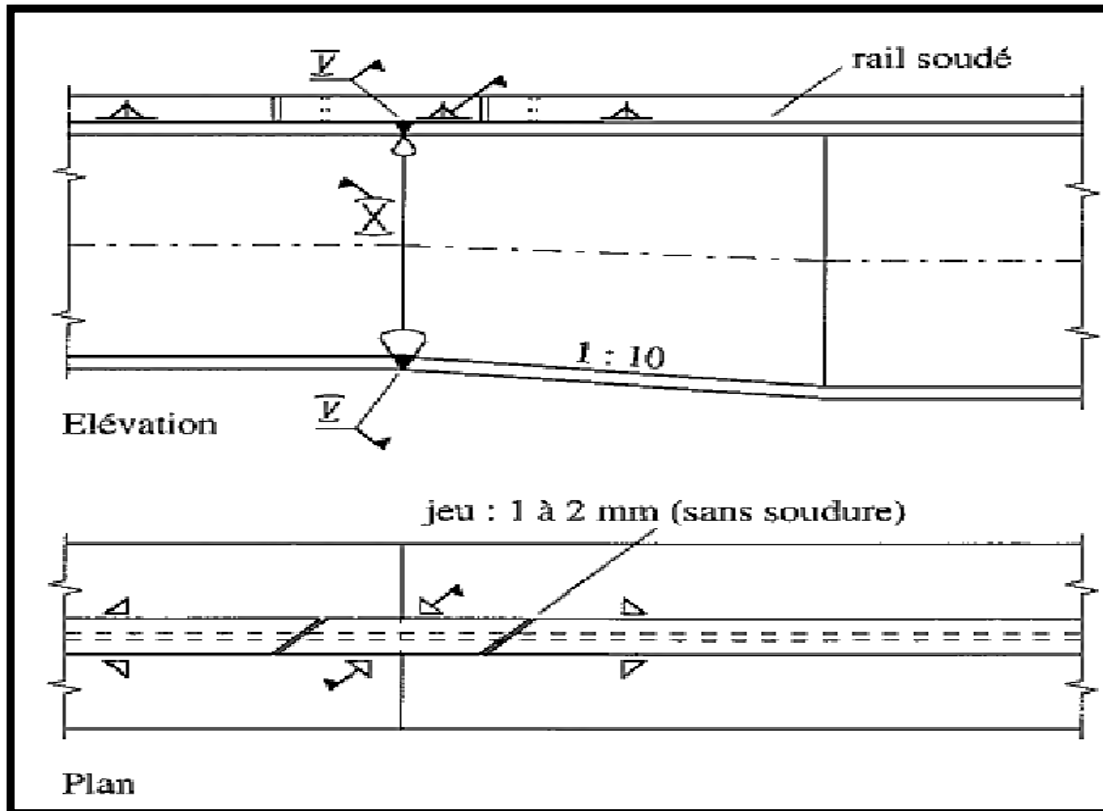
Joint d'une poutre de roulement à rail soudé avec changement de section.
